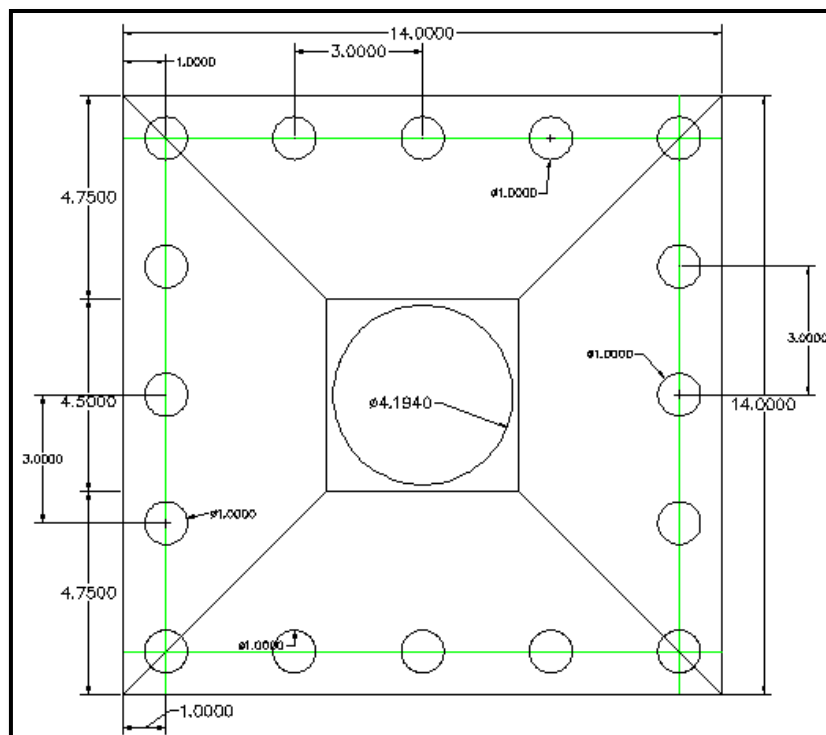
Fundação de torre eólica. Geometria em planta (m).
